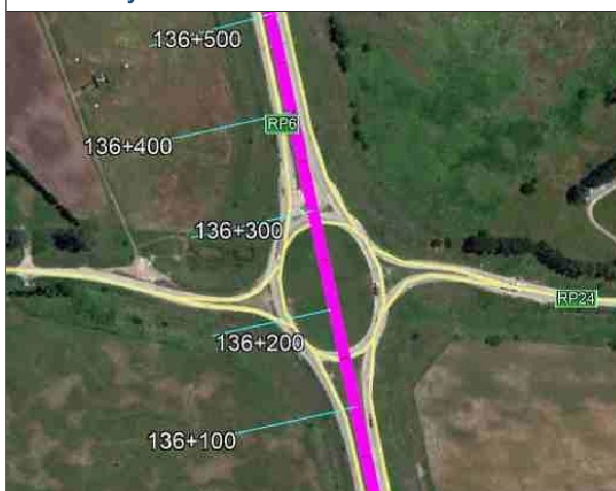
y Foto 229. Intersección RP N°6 con RP N°24
